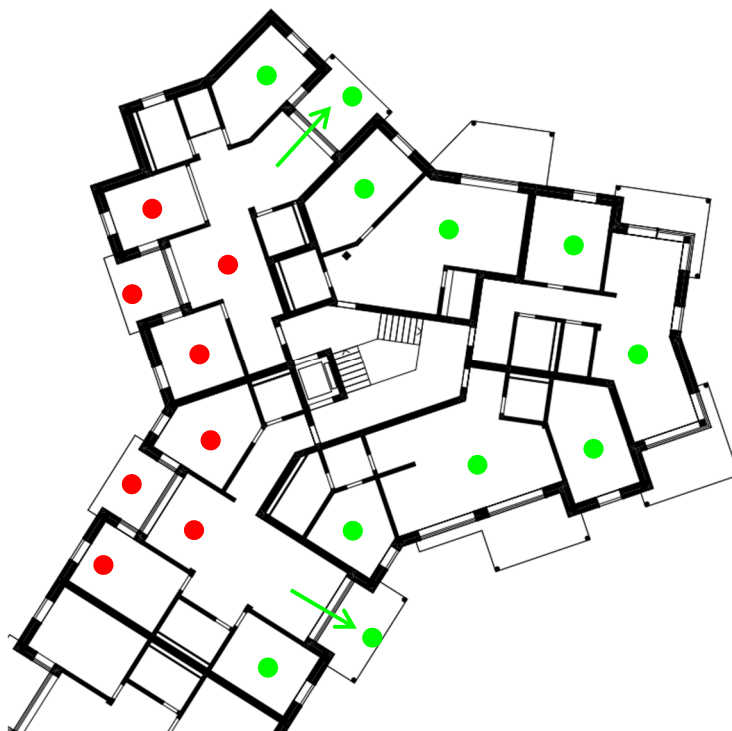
Ausschnitt Grundriss Bau Nord nördlicher Teil Regelschoss
